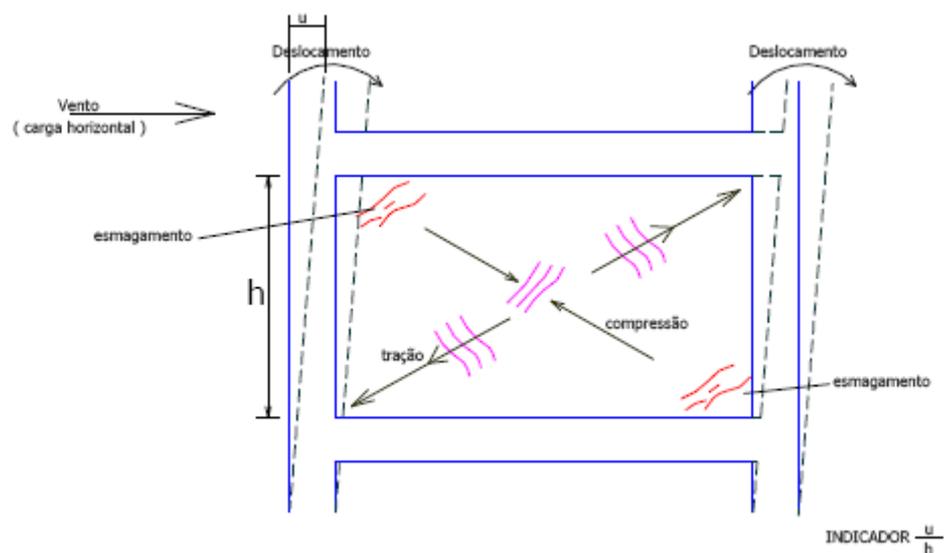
fissuras devido a cargas horizontais (ABCP, 2004)
